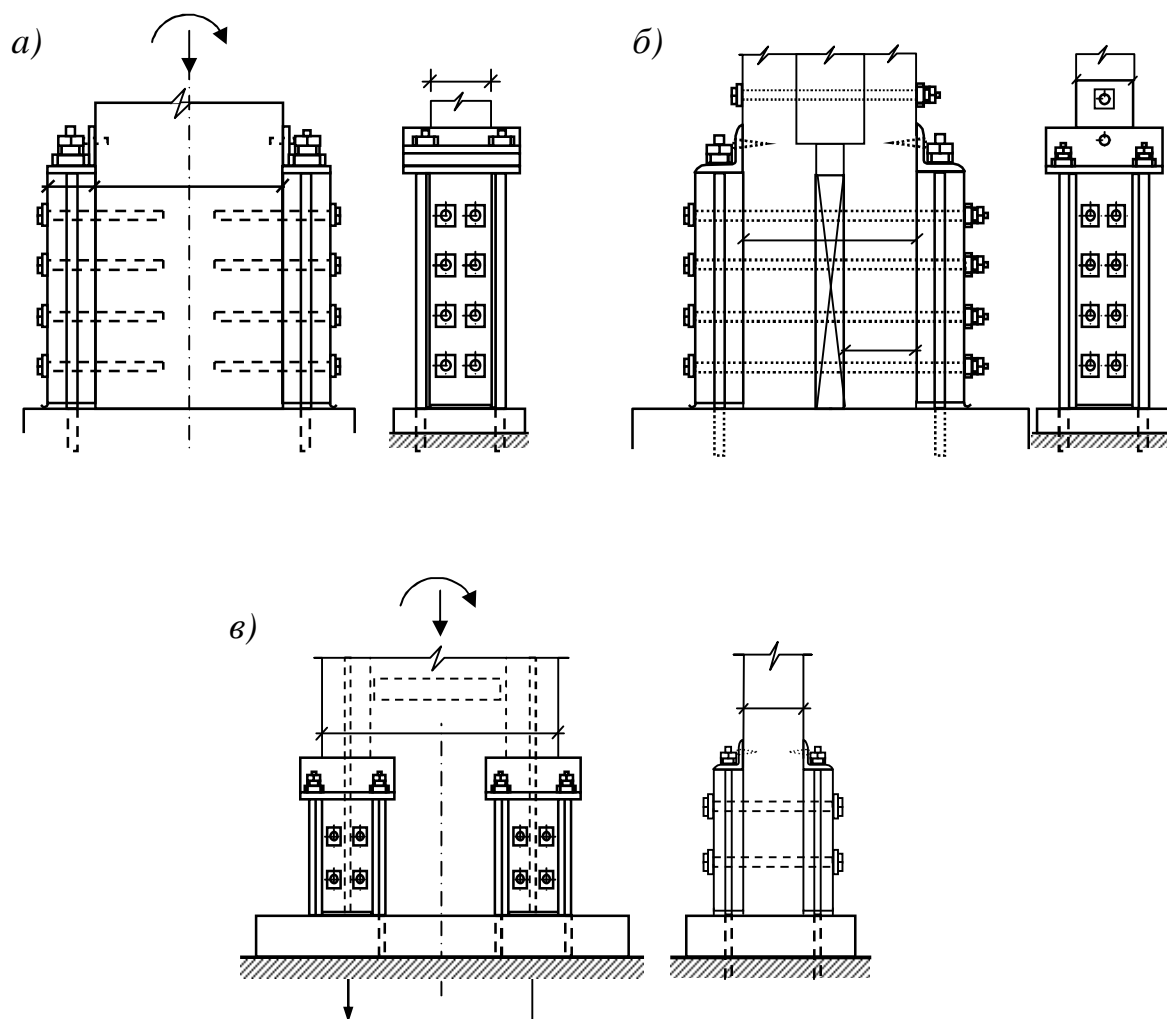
Конструкции закрепления стоек в фундаментах:
